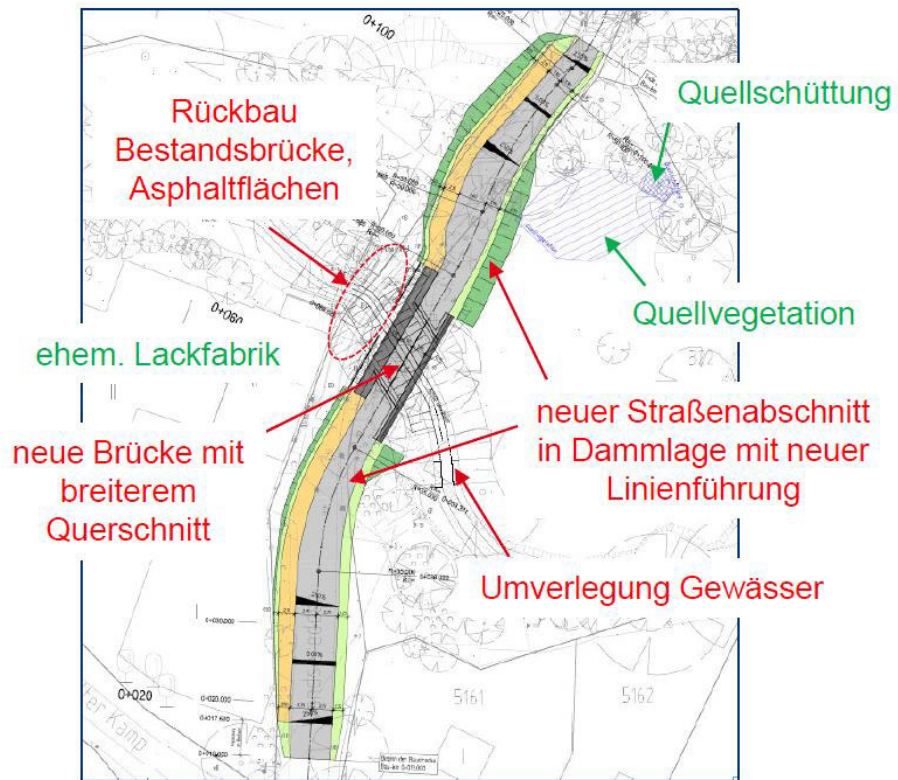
Lageplan neuer Straßenabschnitt (Auszug LOMB)
